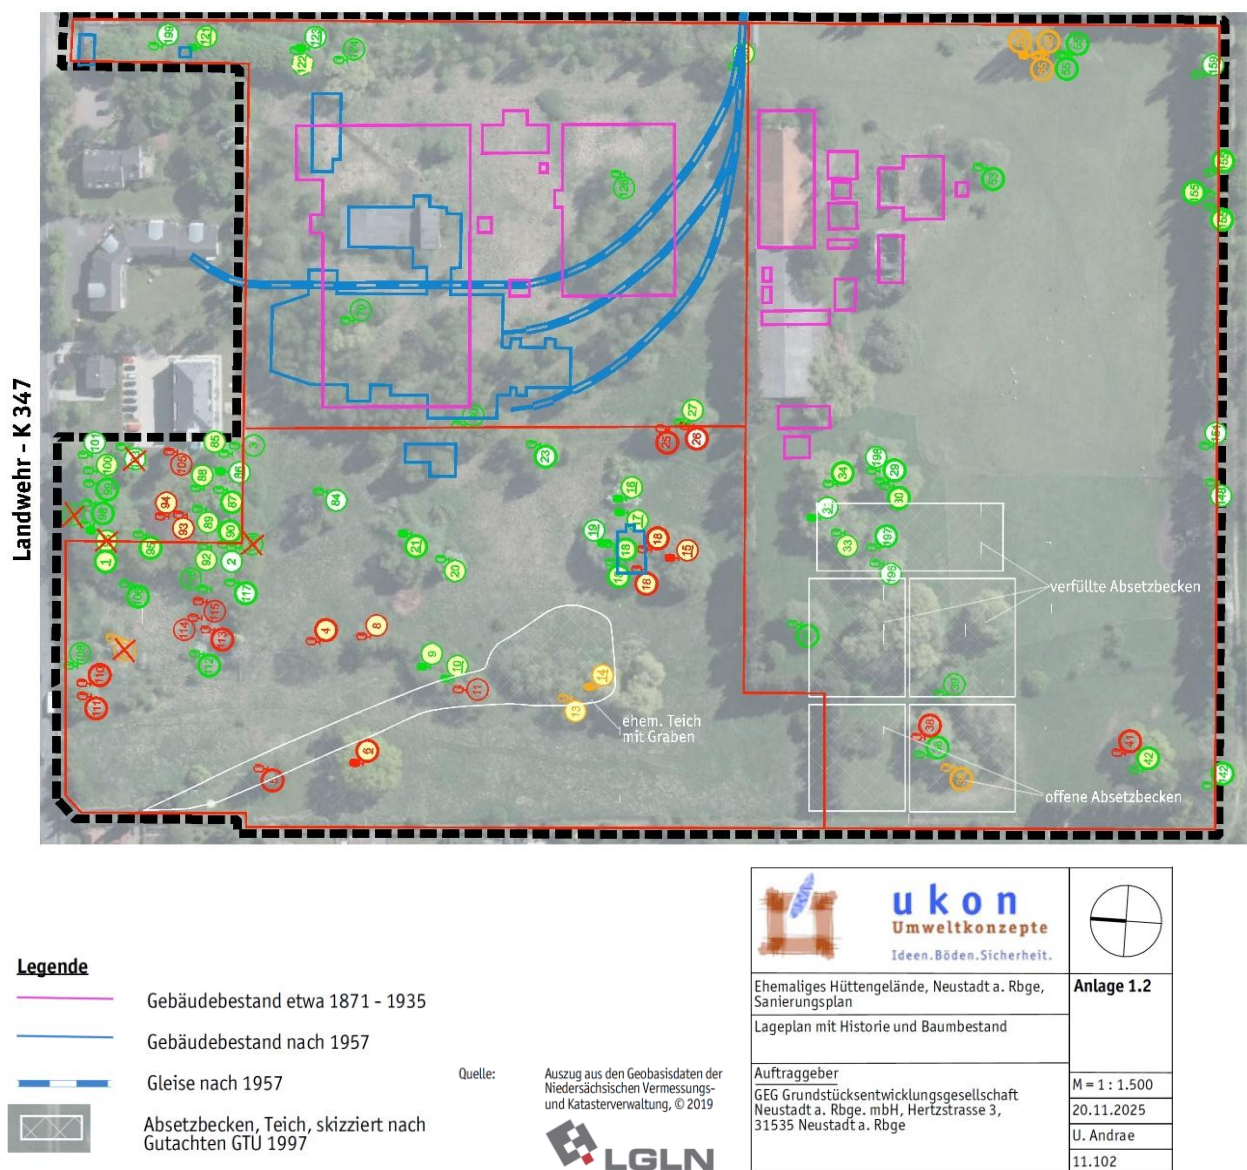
Anlage 1.2. aus dem Sanierungsplan, Lageplan mit Historie, nicht genordet
